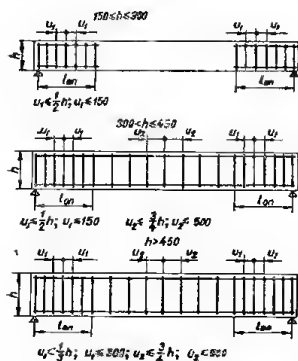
Схемы расположения поперечных стержней в балках без отбитов:
